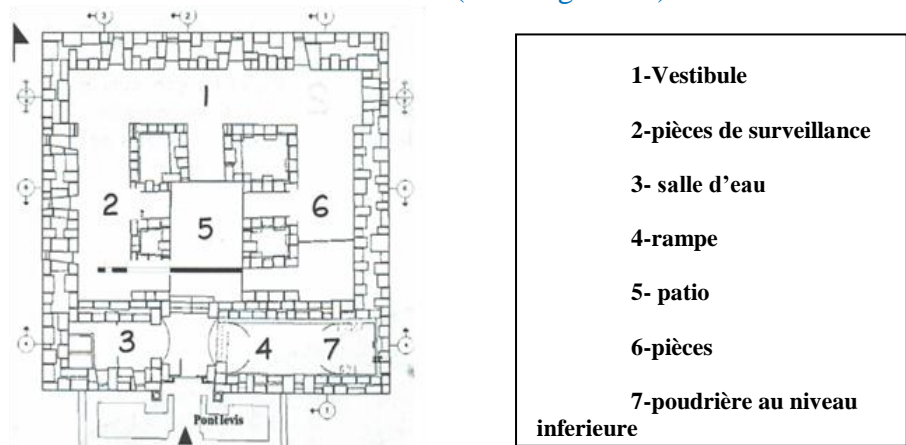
Plan du RDC du fort de Bordj el Kiffan.
